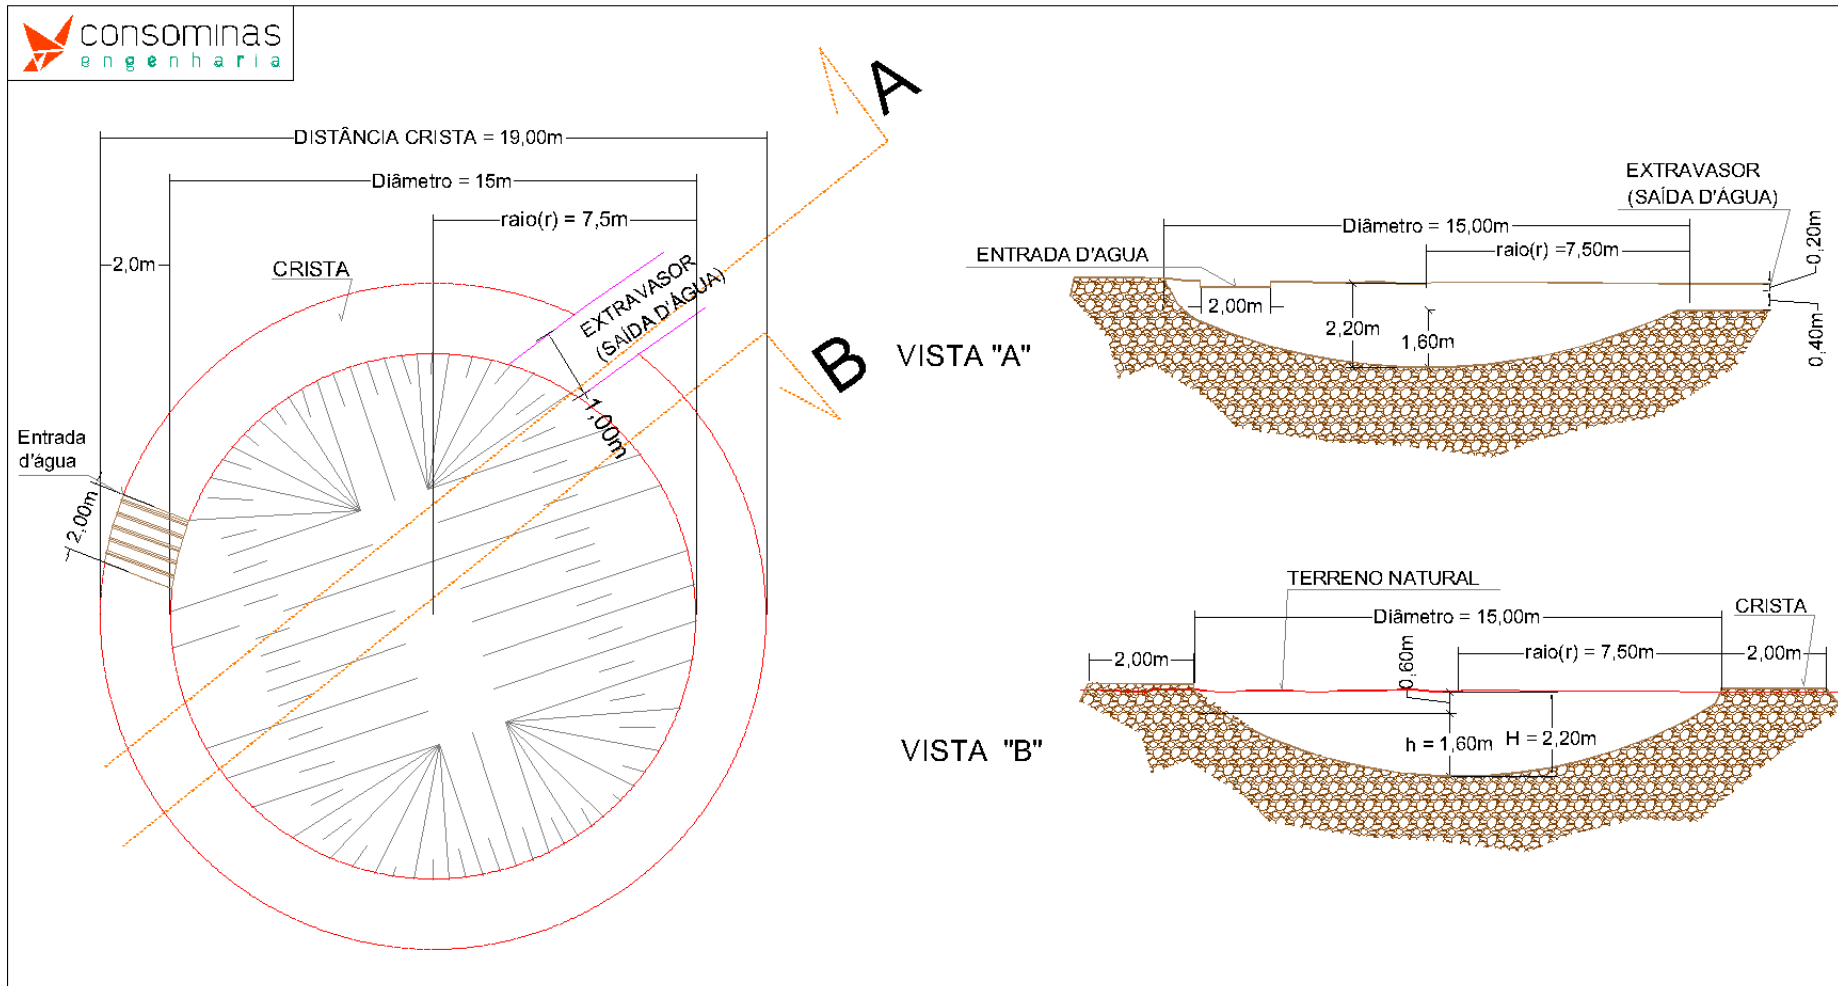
Planta e perfil de bacia de contenção do Tipo II.
